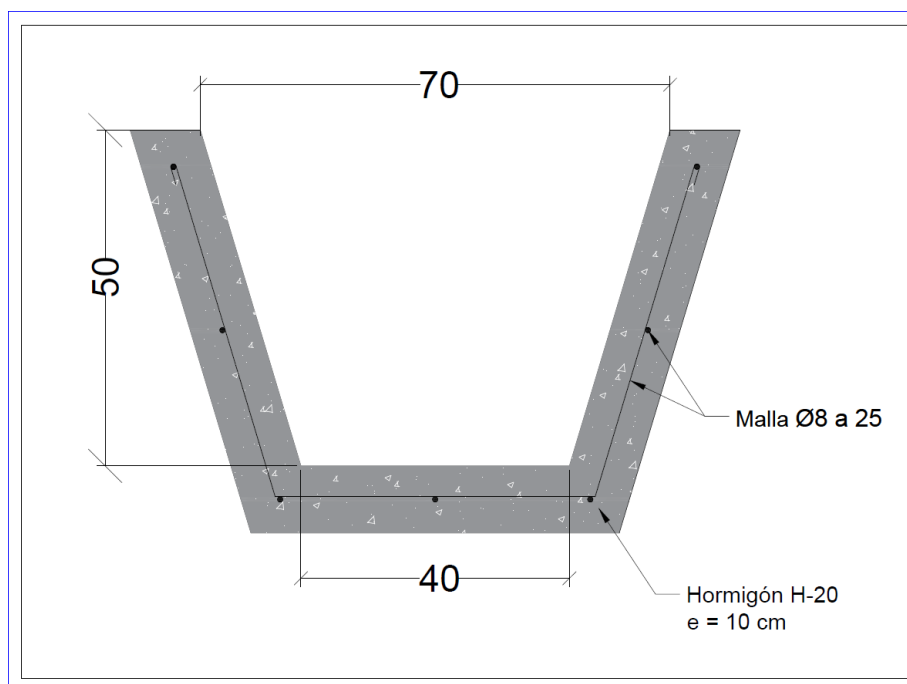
Dimensiones de la cuneta revestida trapezoidal
